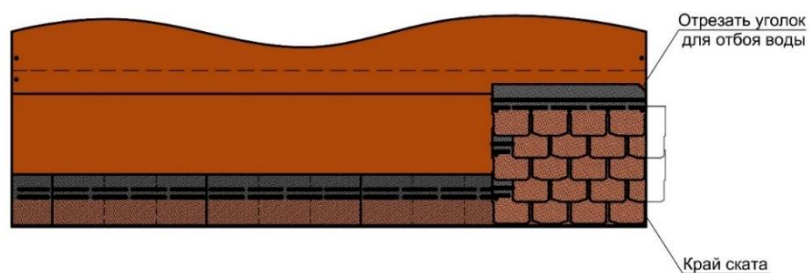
Вертикальный метод укладки гибкой черепицы Döcke нарезки «Сланец» от края ската.
